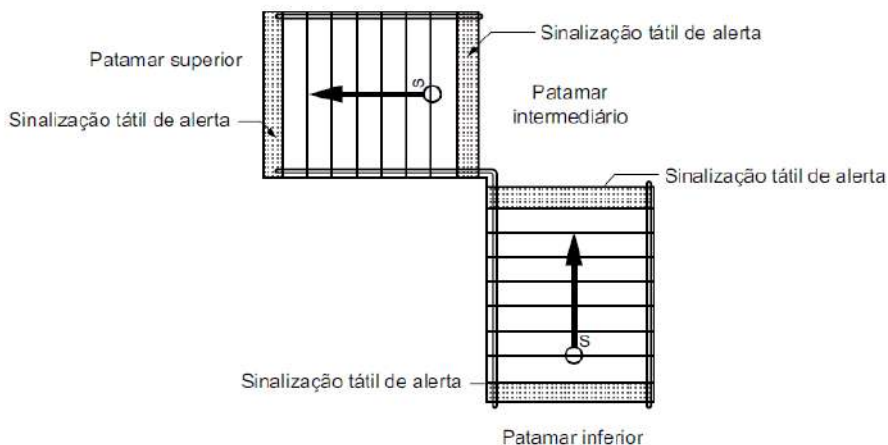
Patamar de escada ou rampa com circulação adjacente
